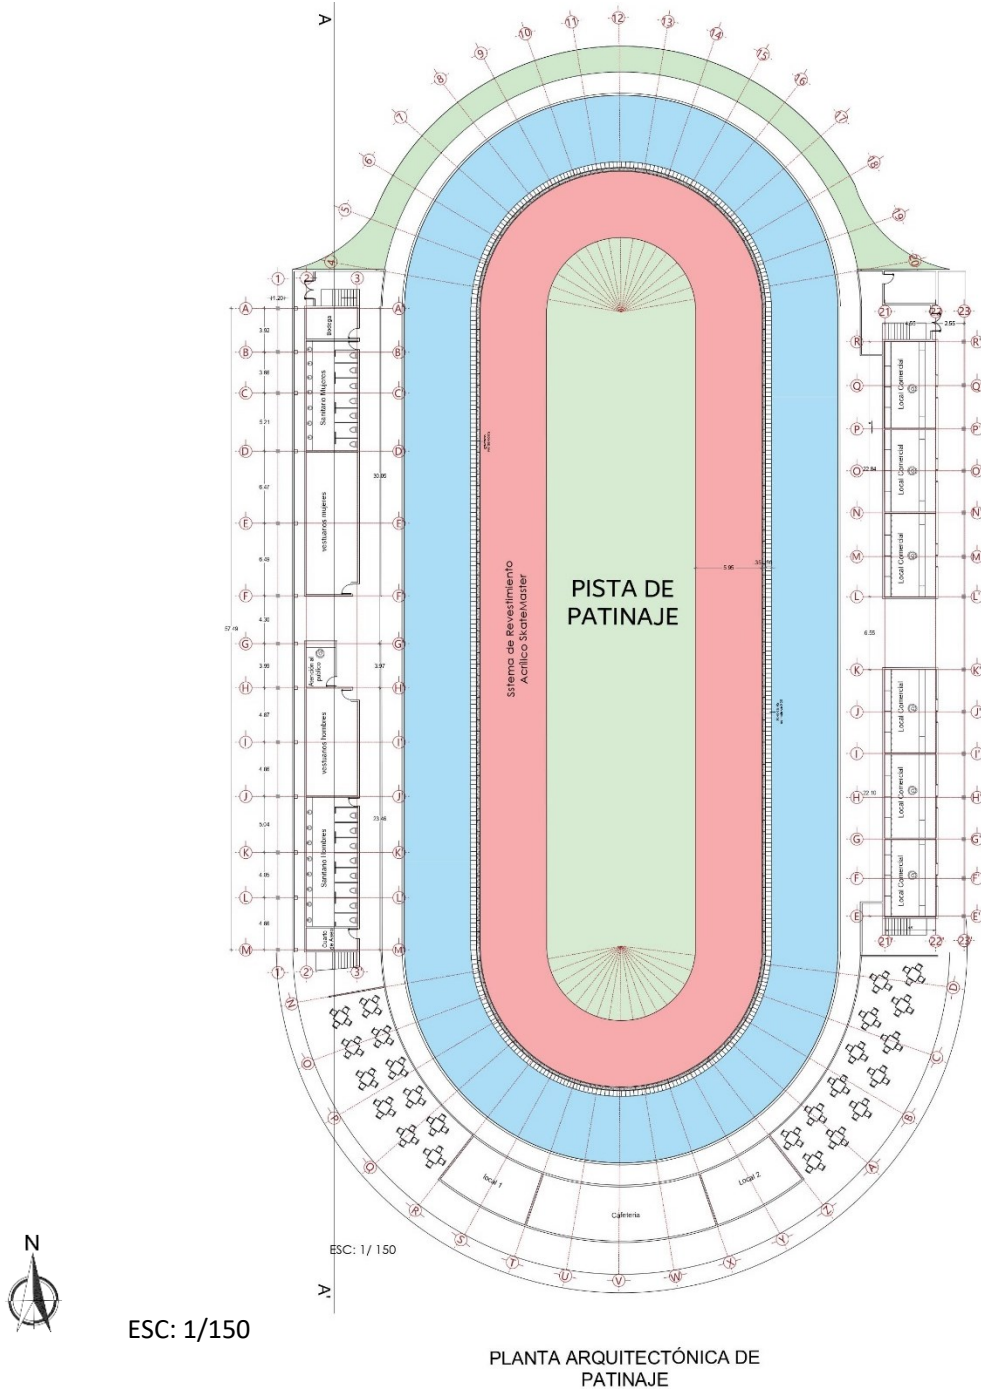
Planta Arquitectónica volumen de Patinaje primer nivel.
